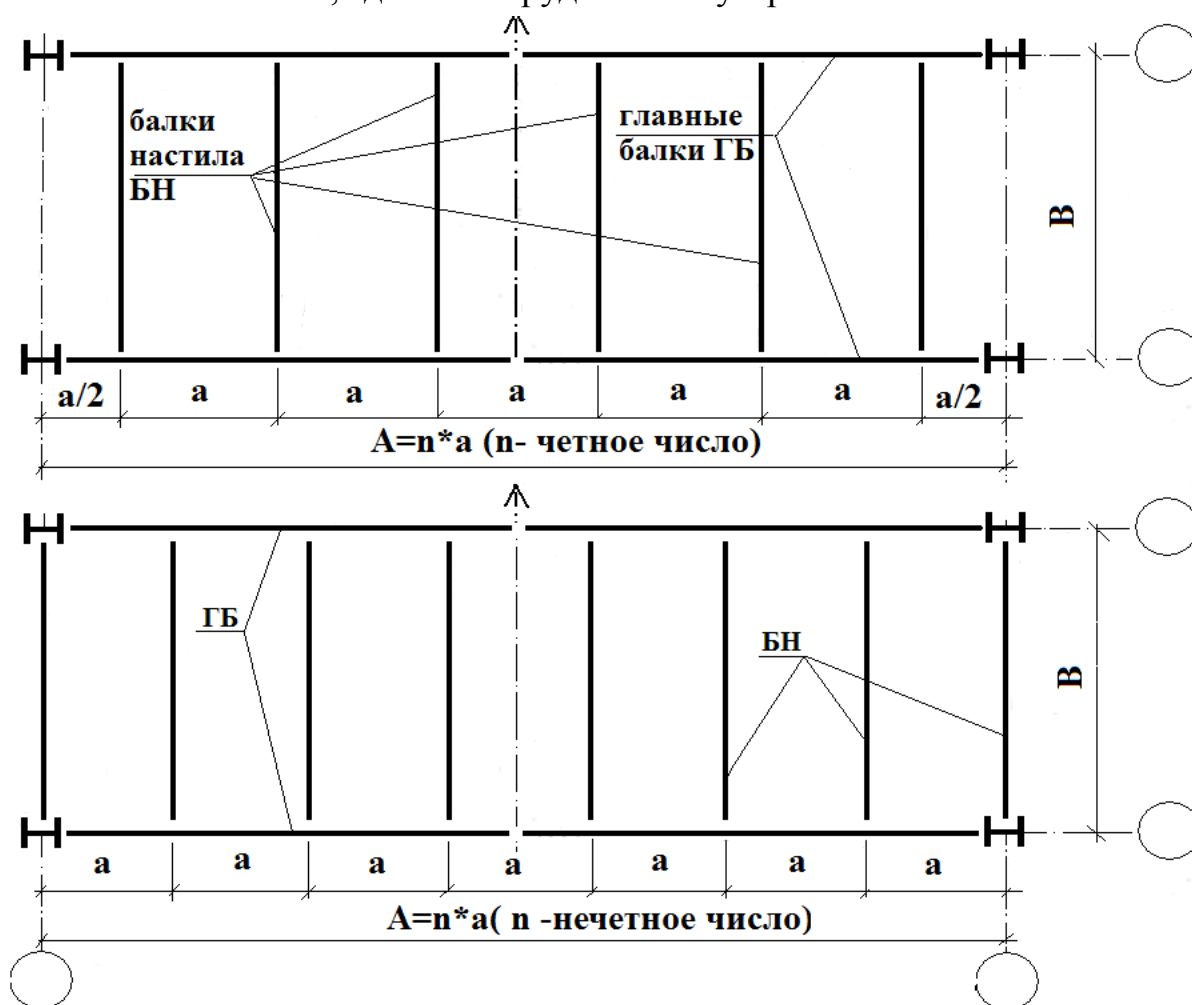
Схемы компоновки балочного перекрытия нормального типа
